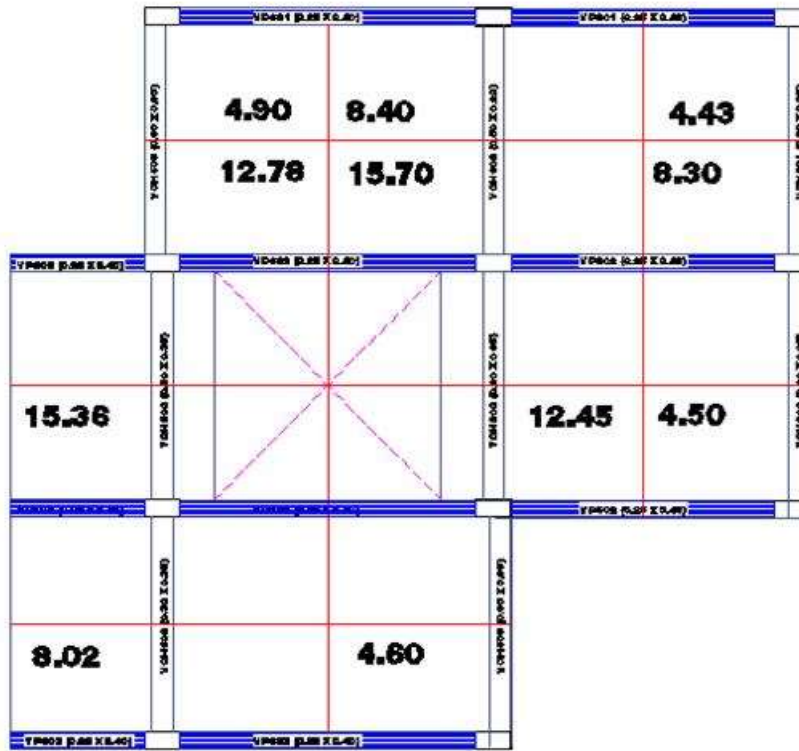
Ubicación en planta y área de tributaria de Columnas – Azotea.
